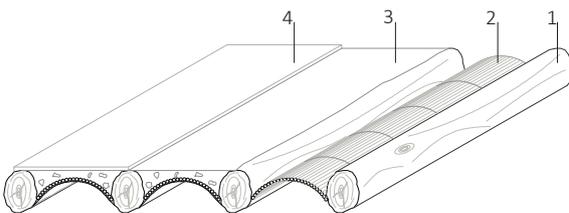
Detalle forjado revoltón yeso y cañizo Fuente: propia
